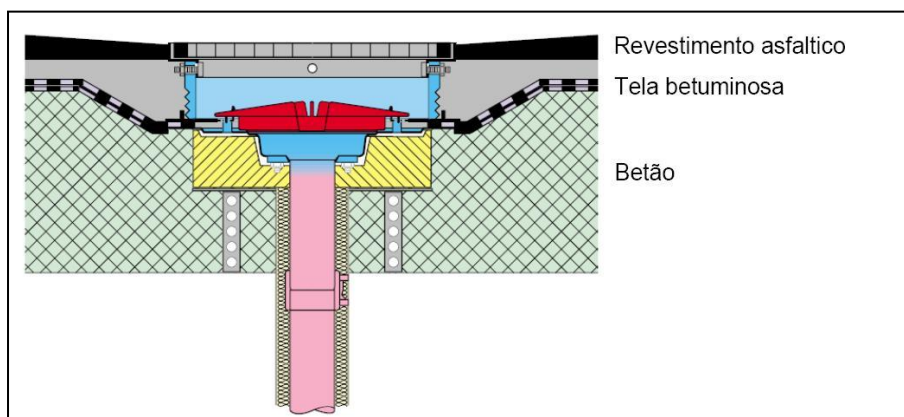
Aplicação em cobertura em betão acessível a automóveis[22]
